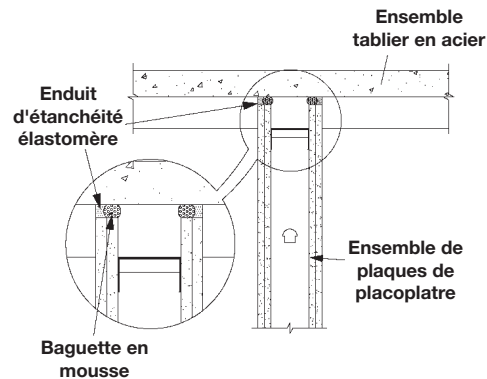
JOINT DE TÊTE-DE-MUR – MUR COMPOSÉS DE PLAQUES DE PLACOPLATRE VERS PLANCHER EN BÉTON
